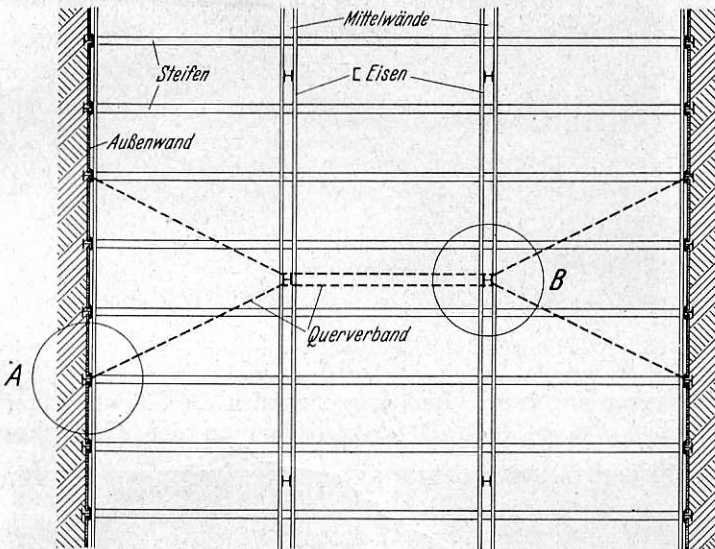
Grundriß einer dreischiffigen Baugrube mit einem waagerechten Querverband, als Doppelsprengewerk ausgebildet.
